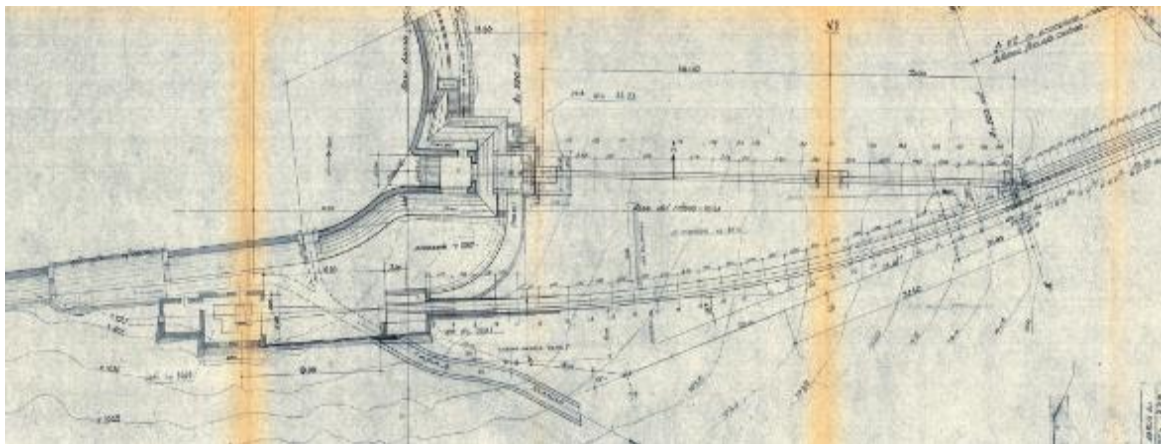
schema planimetrico partenza condotta forzata e staz. arrivo piano inclinato (anno 1958)
